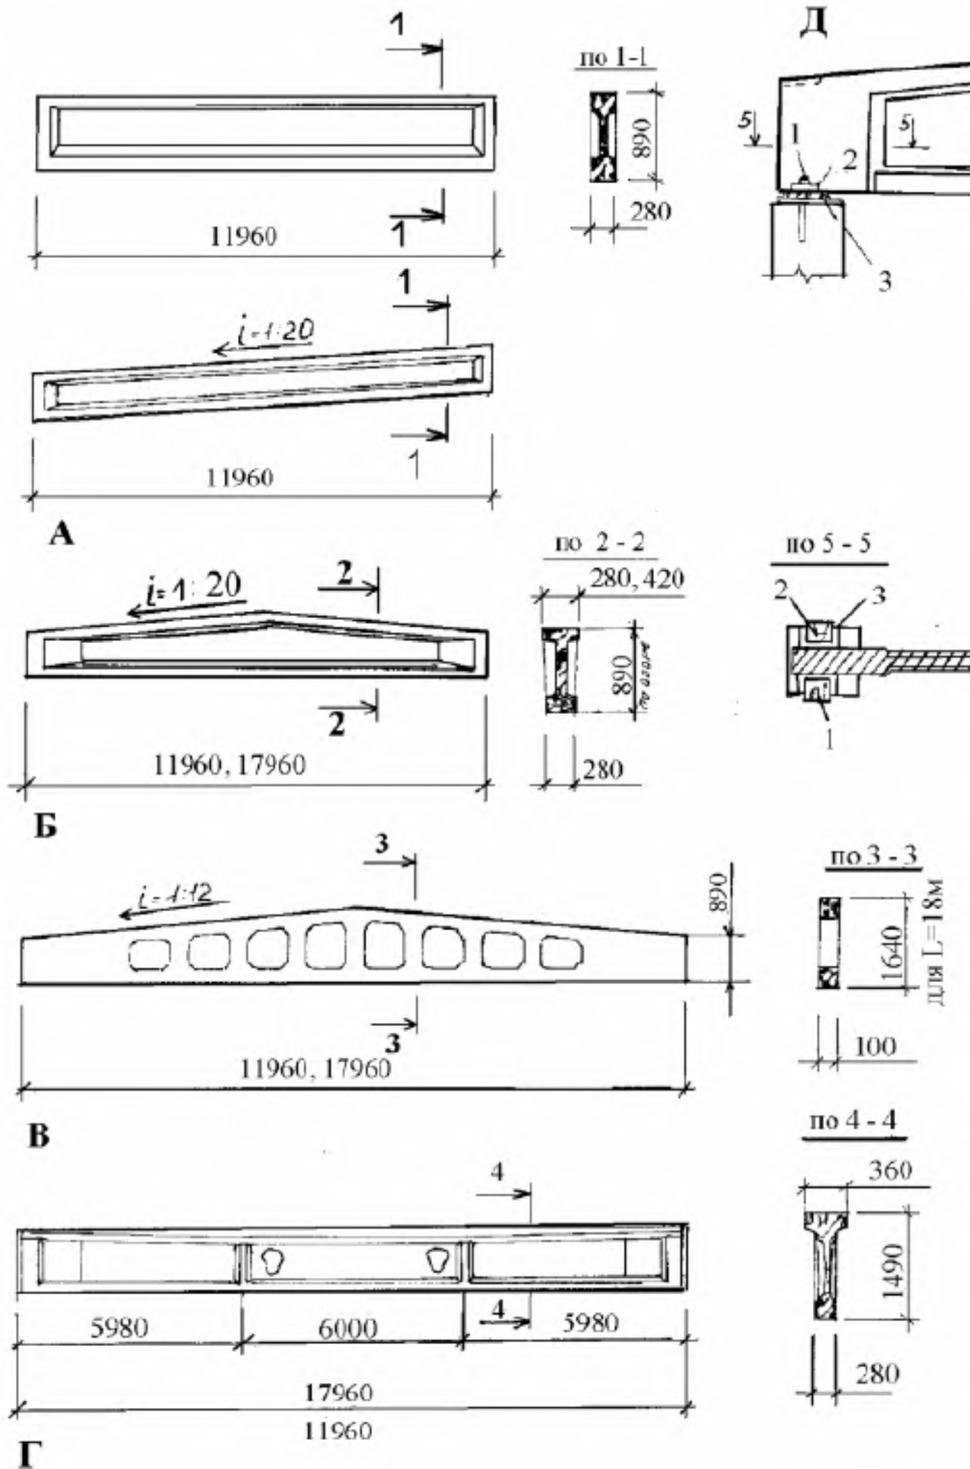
Схеми залізобетонних балок покриття. А, Г — двотаврового перерізу для односкатних покриттів; Б — для багатоскатних покриттів; В —
